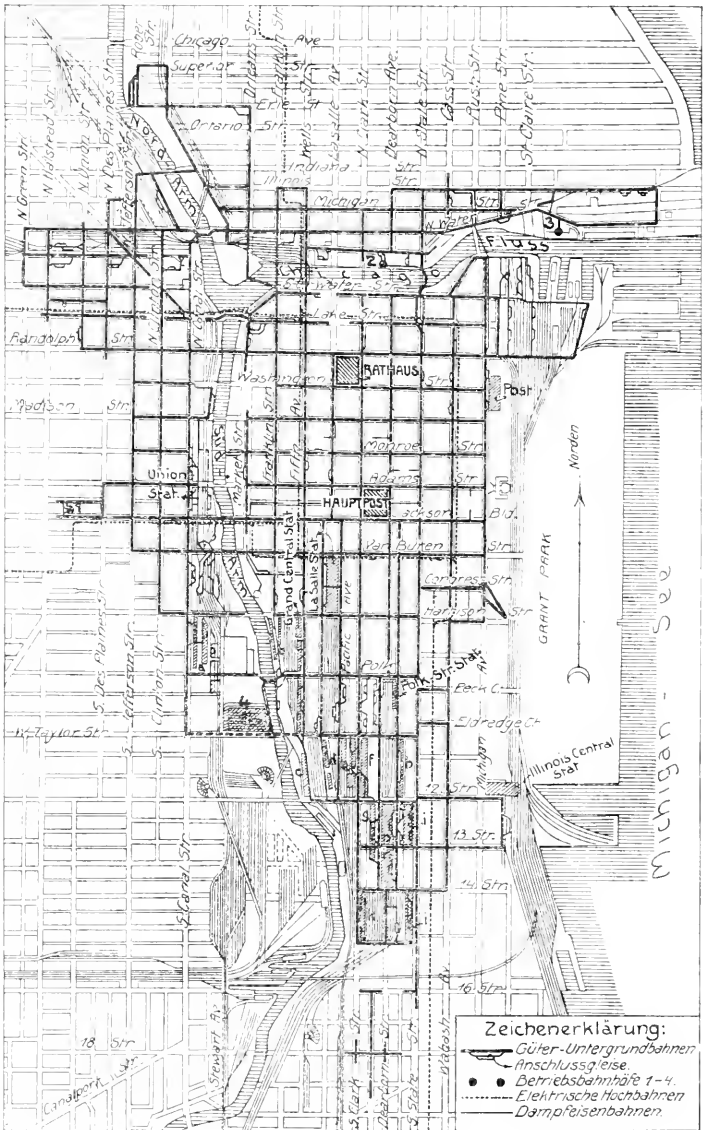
Lageplan der Chicagoer Güteruntergrund-Bahn
